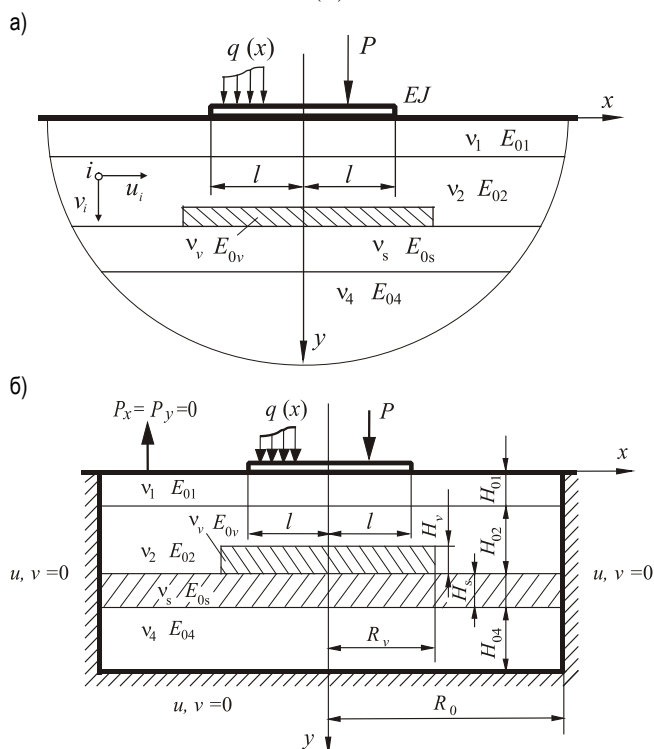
Фундаментная плита на слоистом основании со слабыми полостями
